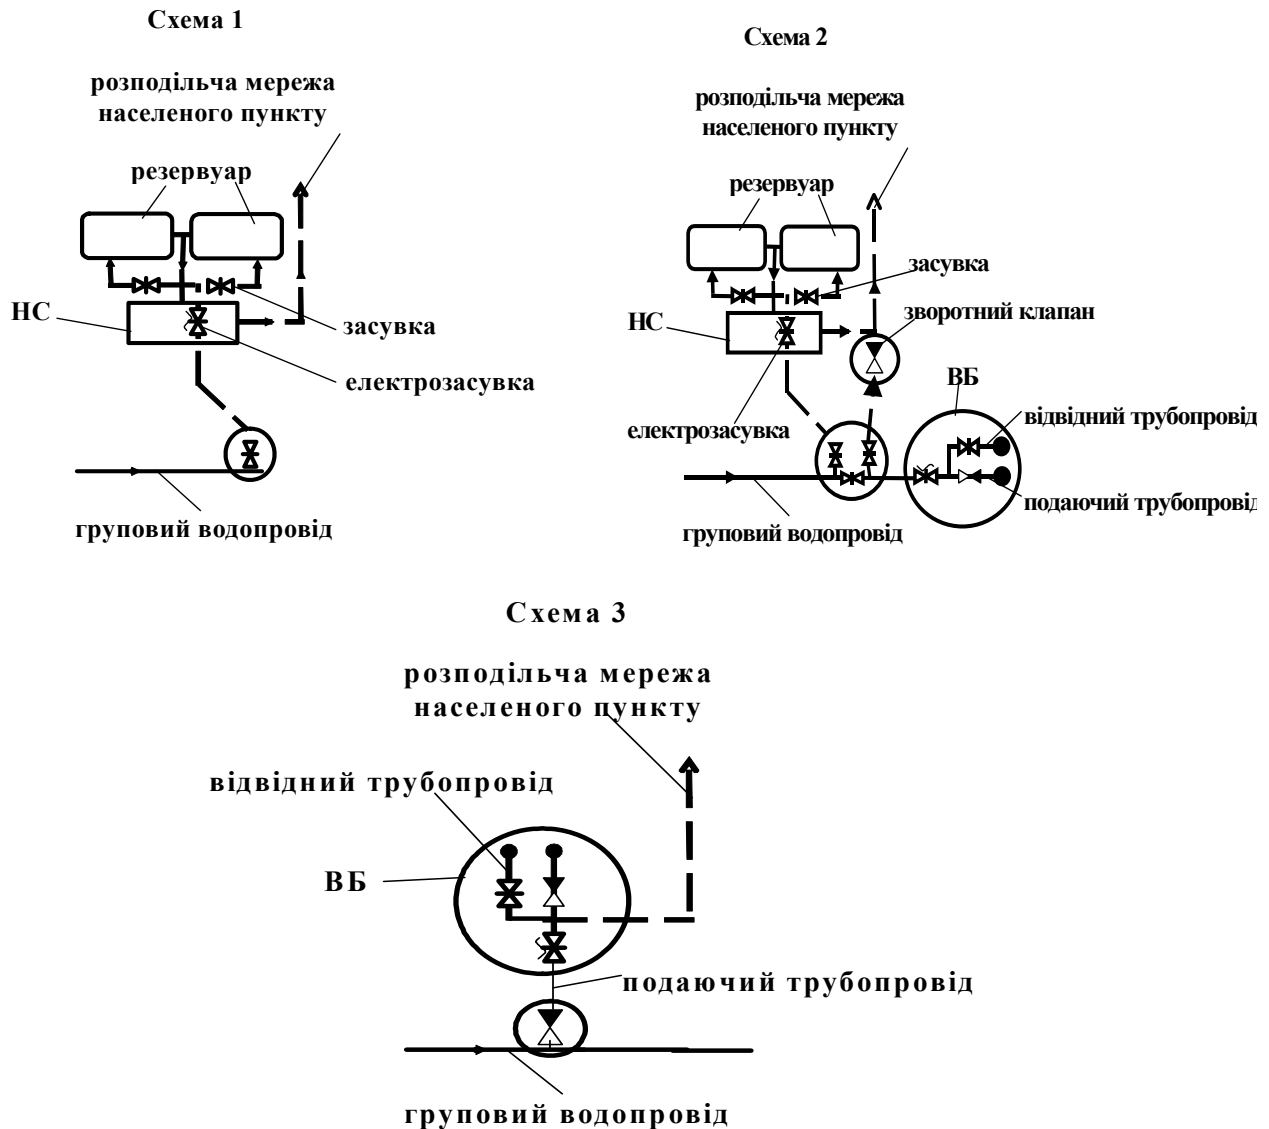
Схеми приєднання селищних систем водопостачання до групового водопроводу
